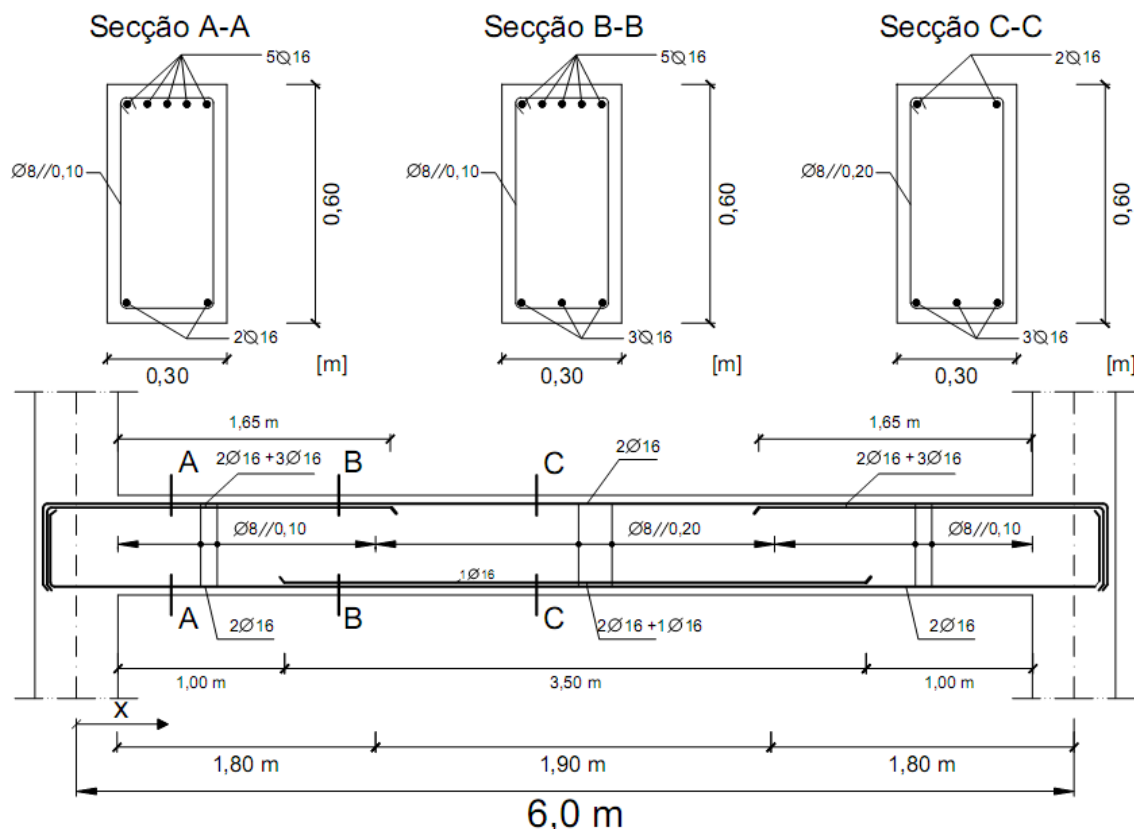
Pormenorização da armaduras (Caso C – secção retangular)
